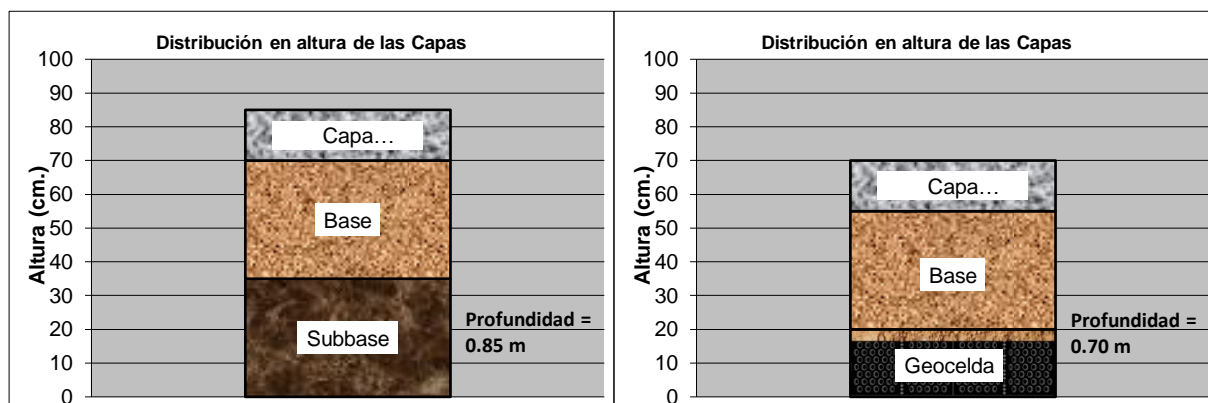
Espesores del pavimento sin reforzar y reforzado con geoceladas para una vía expresa.
